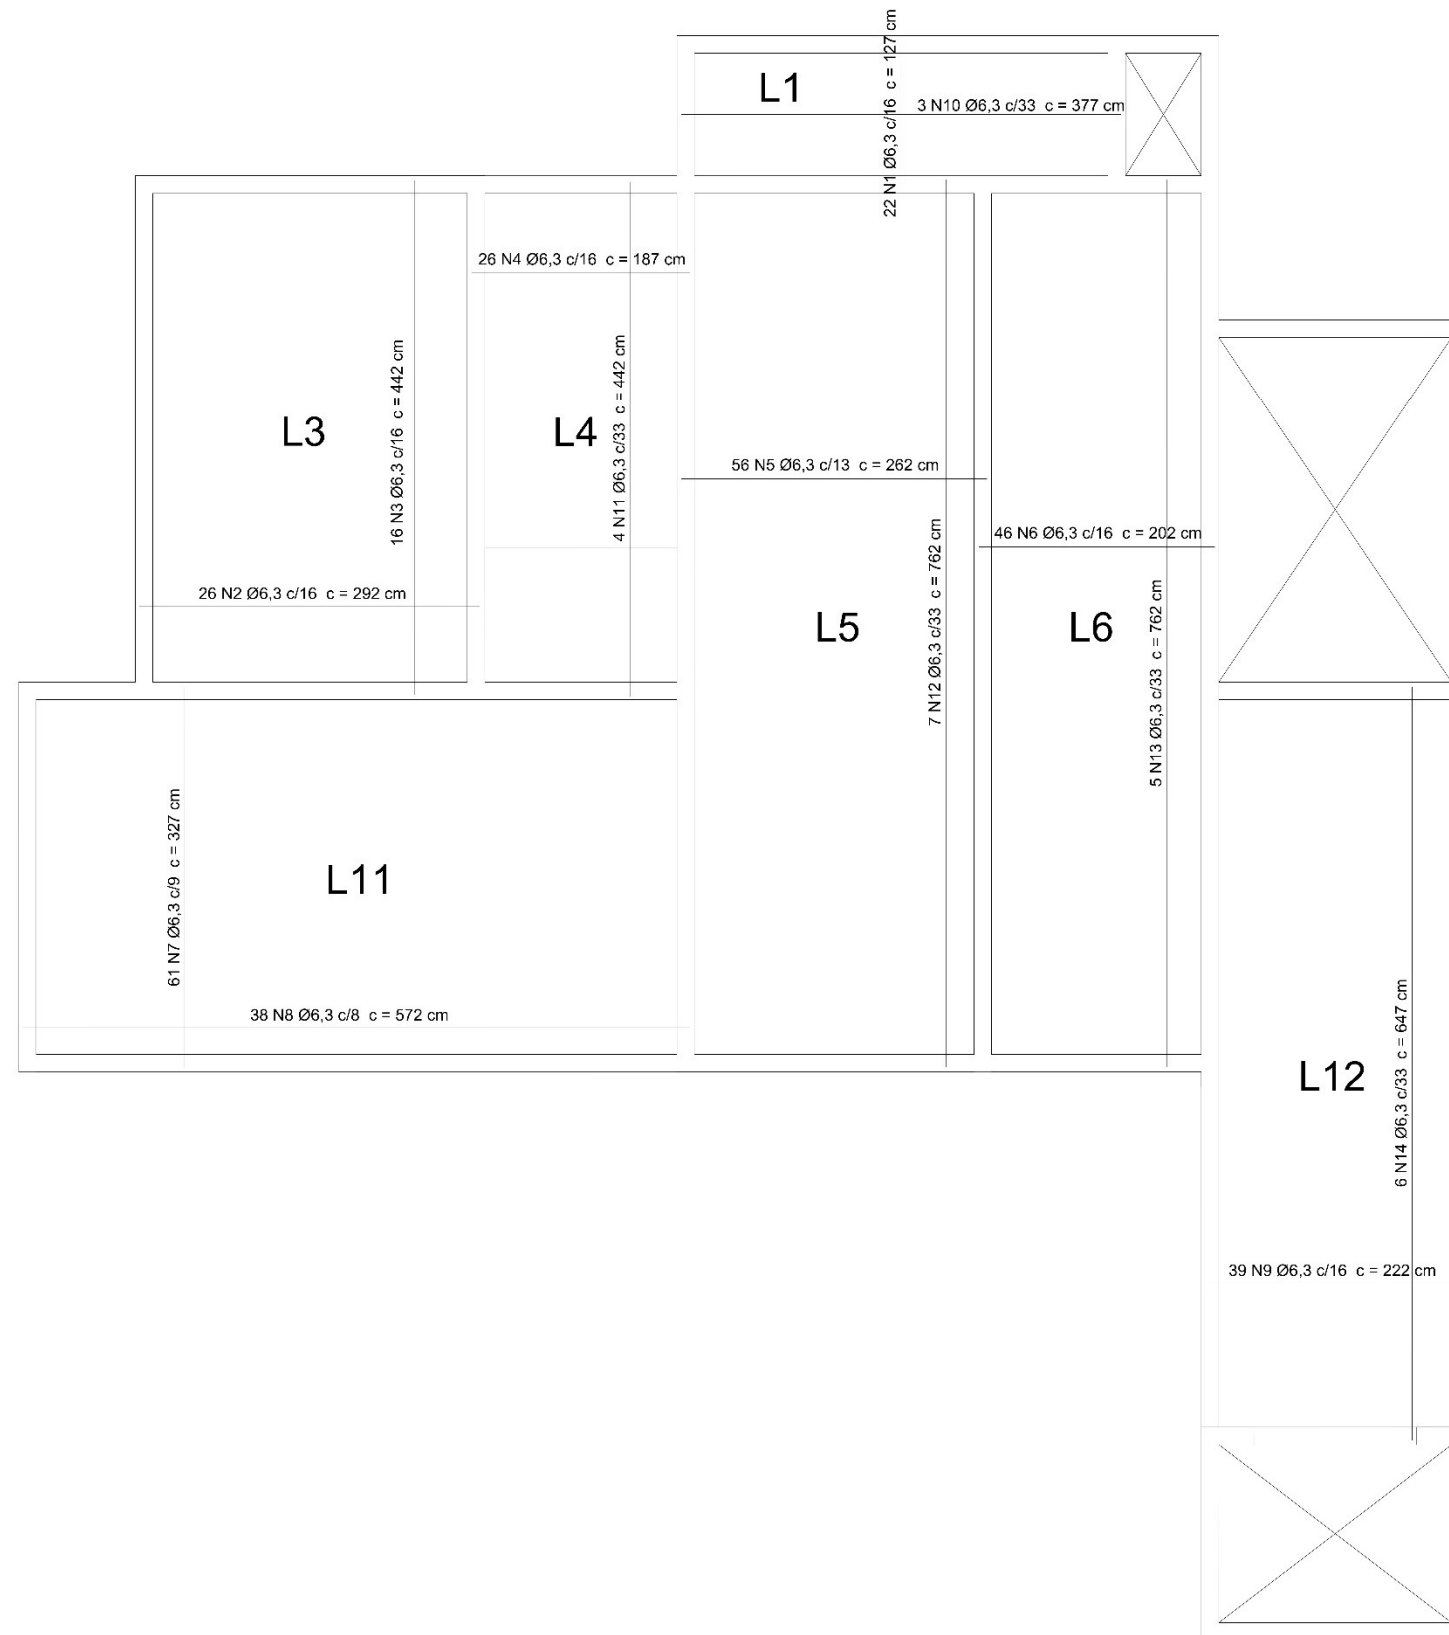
Planta de armadura positiva e de distribuição das lajes armadas com aço
